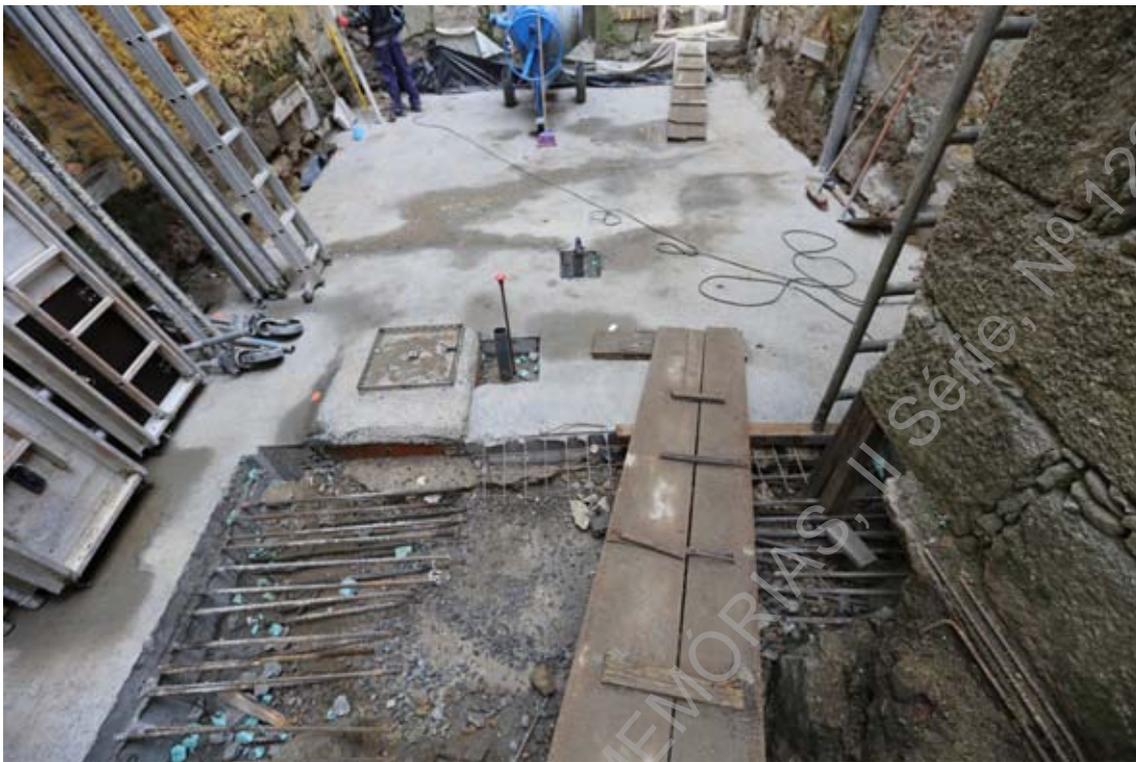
(IMG_4320) – Aspeto final da betonagem do lote.
